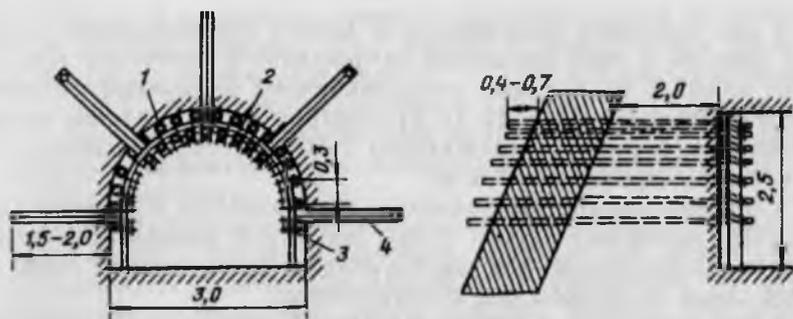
Схема вскрытия выбросоопасного пласта квершлагом с воздействием опережающей крепи:
